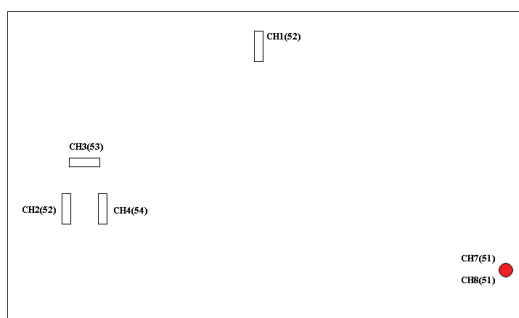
Croquis de disposición de LVDTs en alzado de muro
